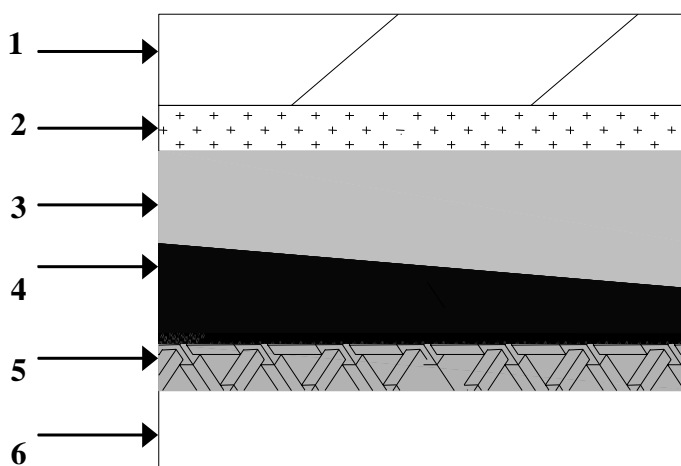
a.1 : coupe transversal du plancher terrasse inaccessible
